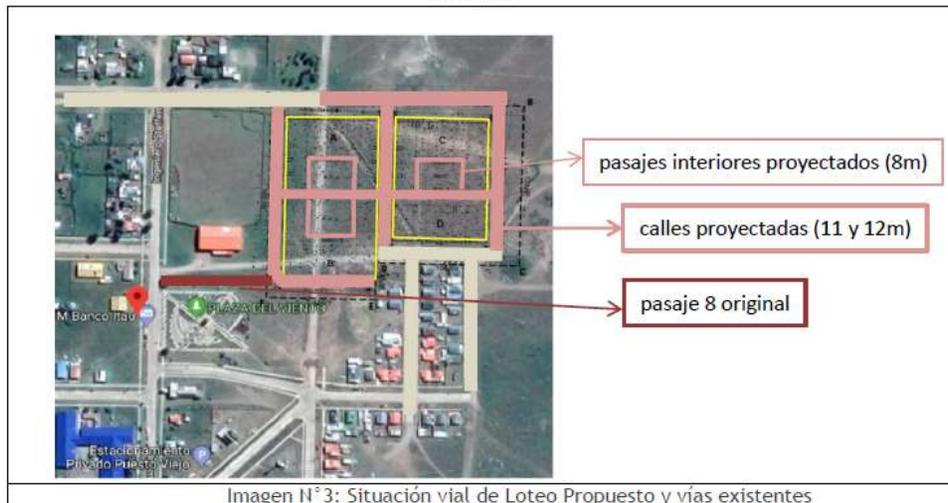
Situación vial de Loteo Propuesto y vías existentes
